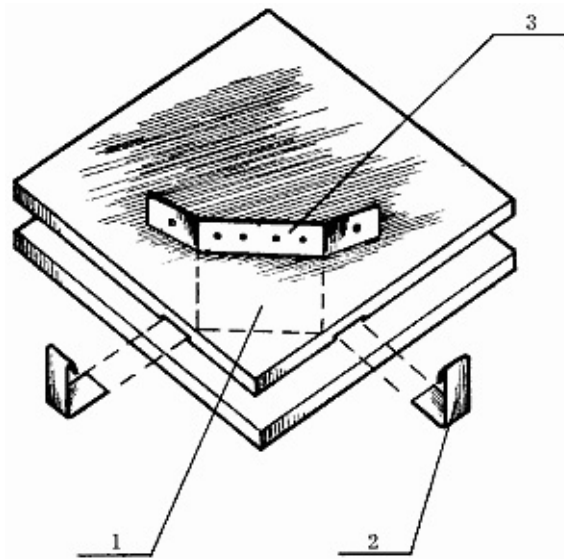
Подготовка плиток для устройства потолка: 1 – облицовочная плитка; 2 – закладные крюки; 3 – крепежная скоба.
